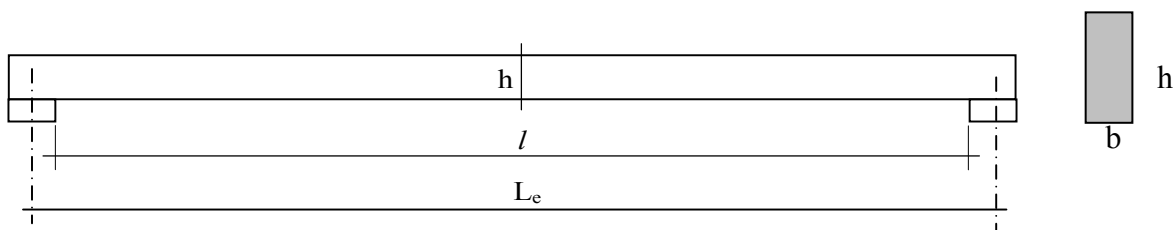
Vãos da viga sobre os aparelhos de apoio e seção transversal
